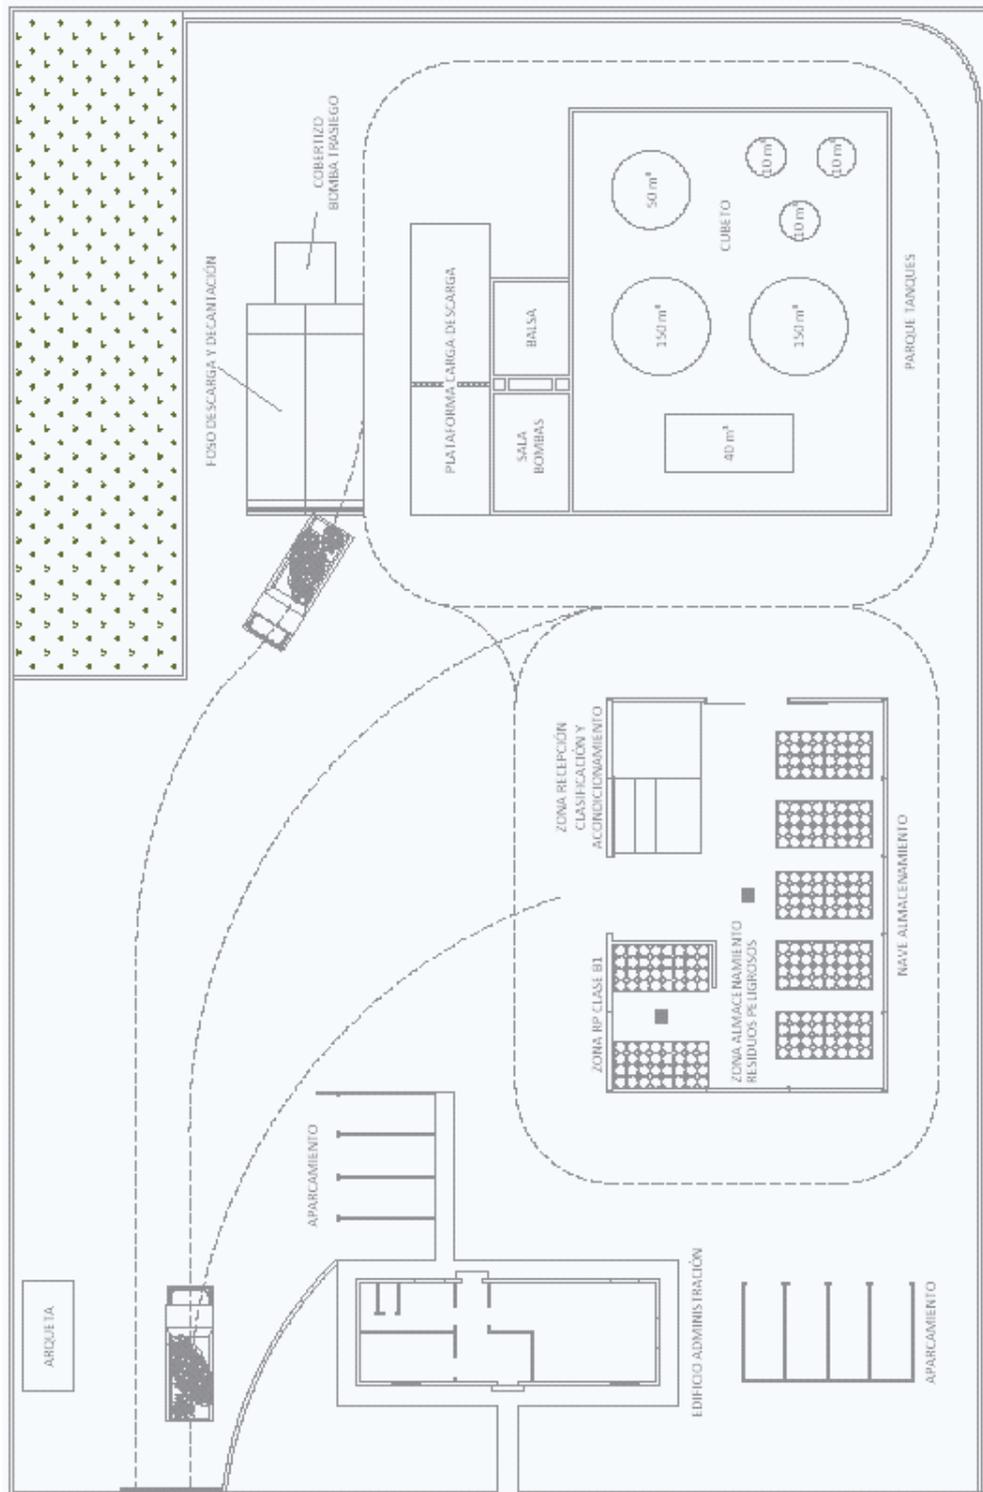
Plano en planta de instalaciones, infraestructuras y equipos.
